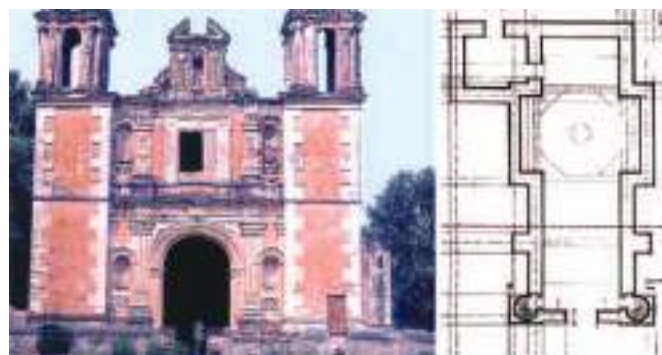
Fachada y planta arquitectónica de la Capilla de Los Reyes, en la Hacienda “Los Reyes”, Tlaxcala.
